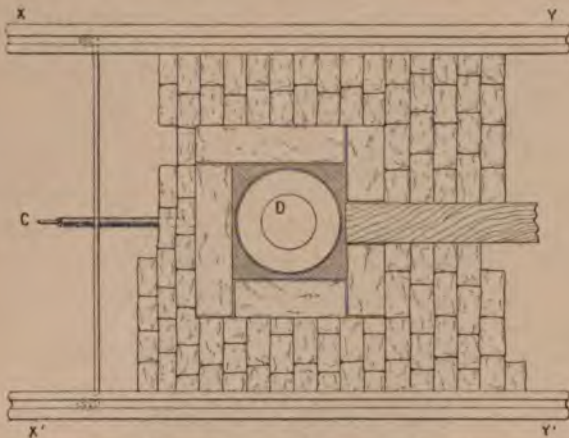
Vue en plan de la voie montrant la disposition d'un distributeur.
